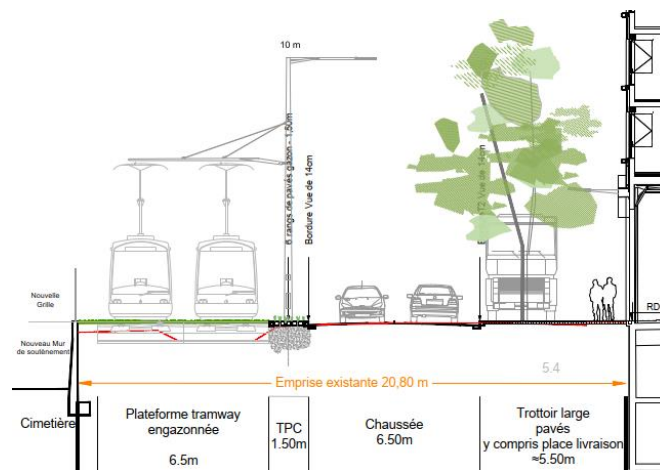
COUPE ET VUE EN PLAN DE LA ROUTE DE BISCHWILLER SUD
